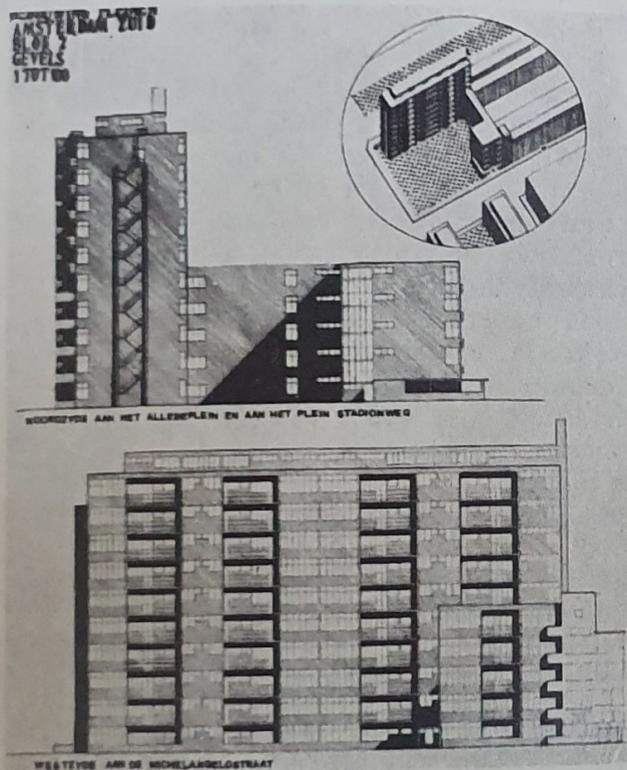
Merkelbach & Karsten, Amsterdam. Proyecto de edificios de viviendas en Amsterdam.
